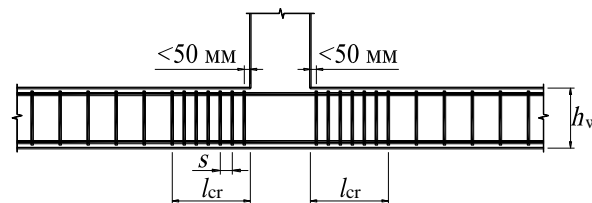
Поперечное армирование в критических зонах балок, поддерживающих прерванные вертикальные колонны
